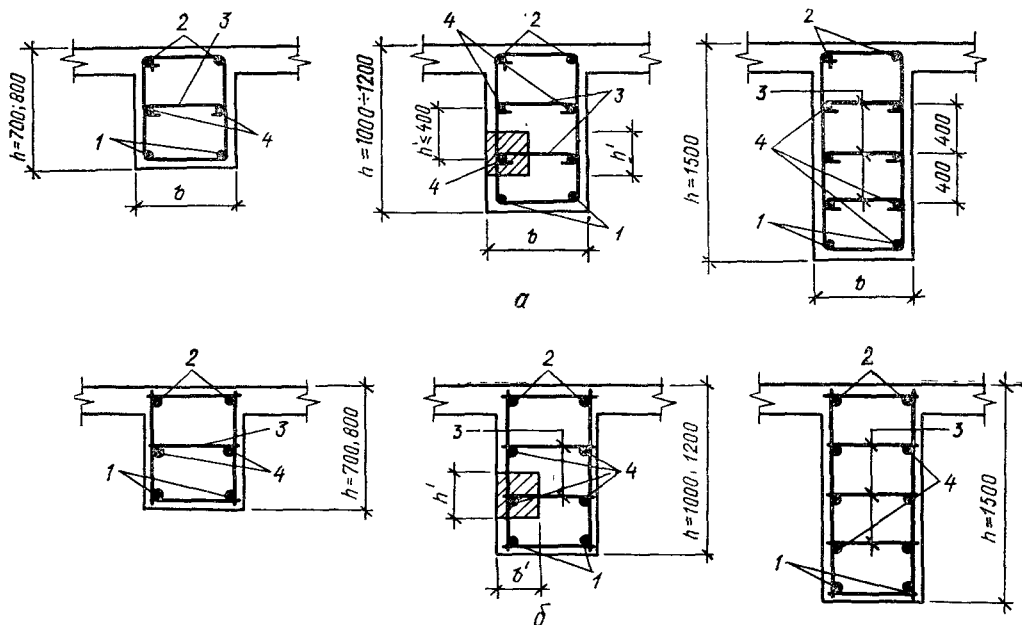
Размещение конструктивных стержней по высоте боковых граней балок при вязаных (а) и сварных (б) каркасах:
